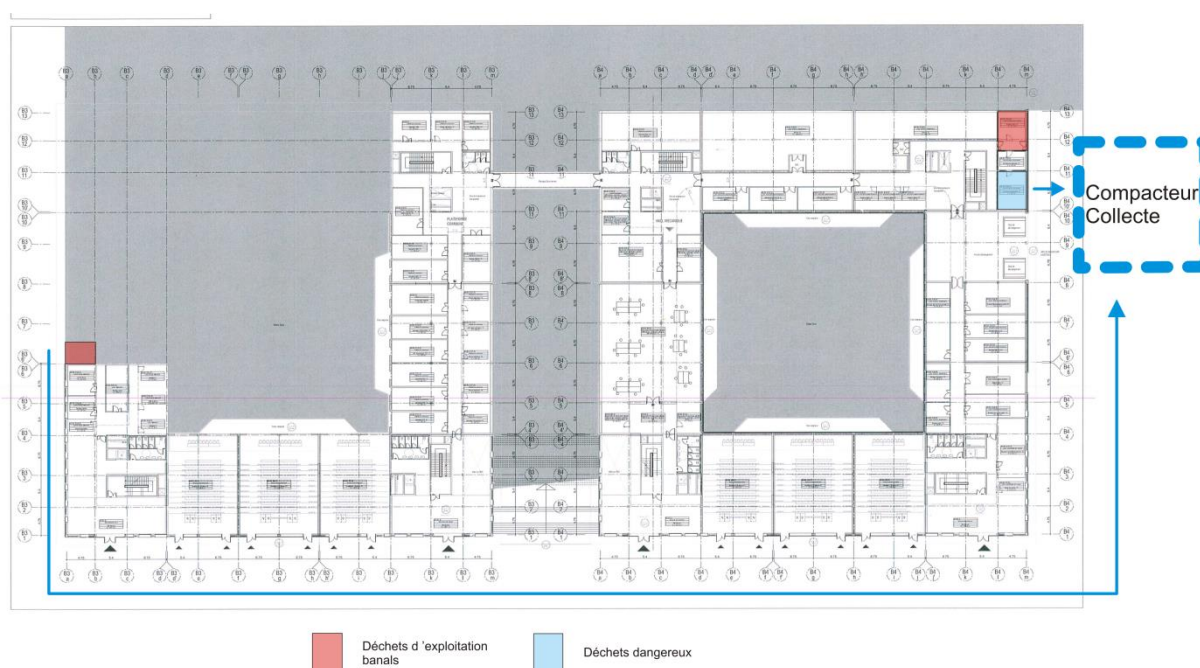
Localisation des locaux déchets sur les plans APD du rez-de-chaussée B3 et B4
